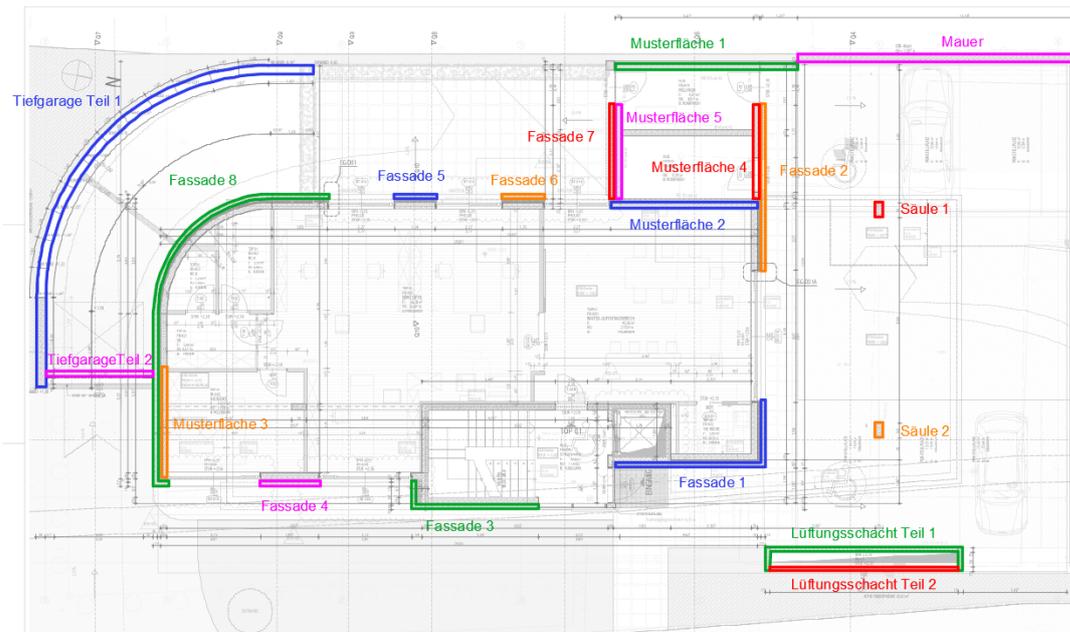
Planliche Darstellung der Sichtbetonwände im Erdgeschoß
